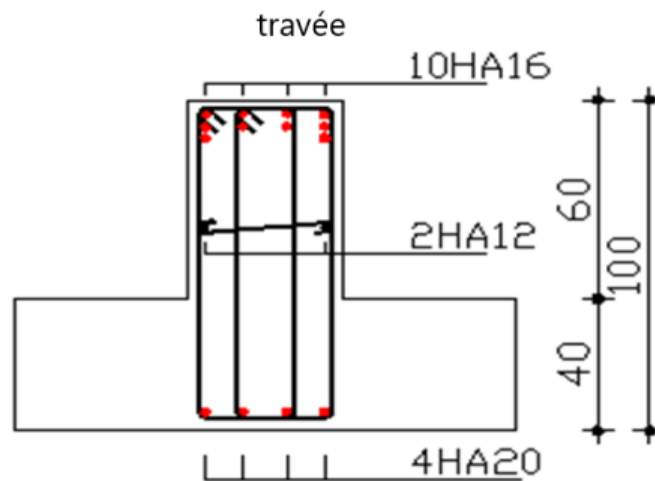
Ferrailage de la poutre principale en travée
